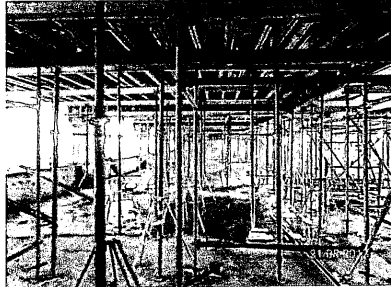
y 24 INTERIOR PRIMER PISO
